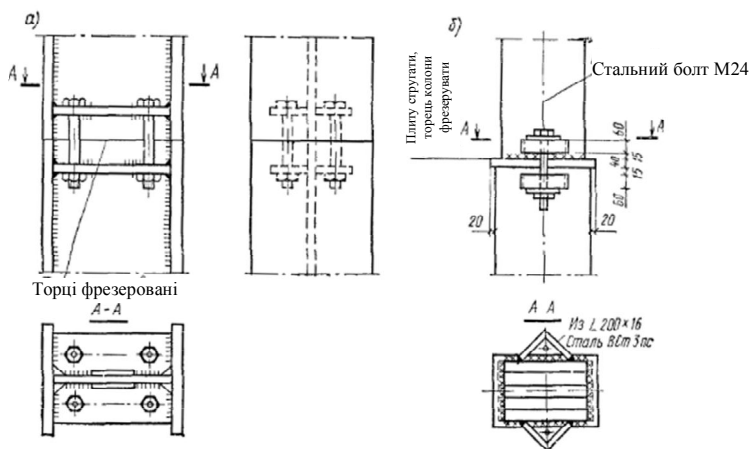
Стиги колон з фрезеруваннями торців і стяжними болтами: а – торці фрезеровані; б – стик через стругану плиту
